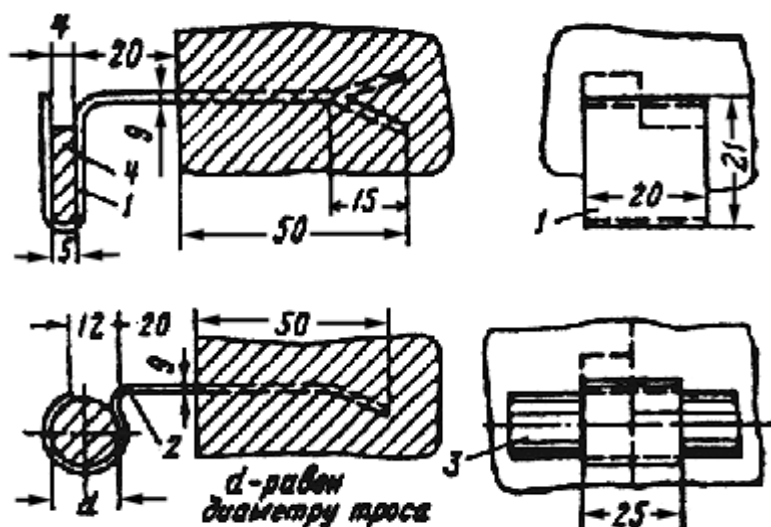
Крепление заземляющего проводника в камере с бетонной крепью:
